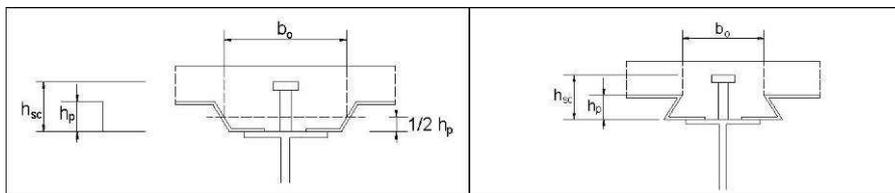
(a) - Disposizione della lamiera grecata rispetto al profilo in acciaio
